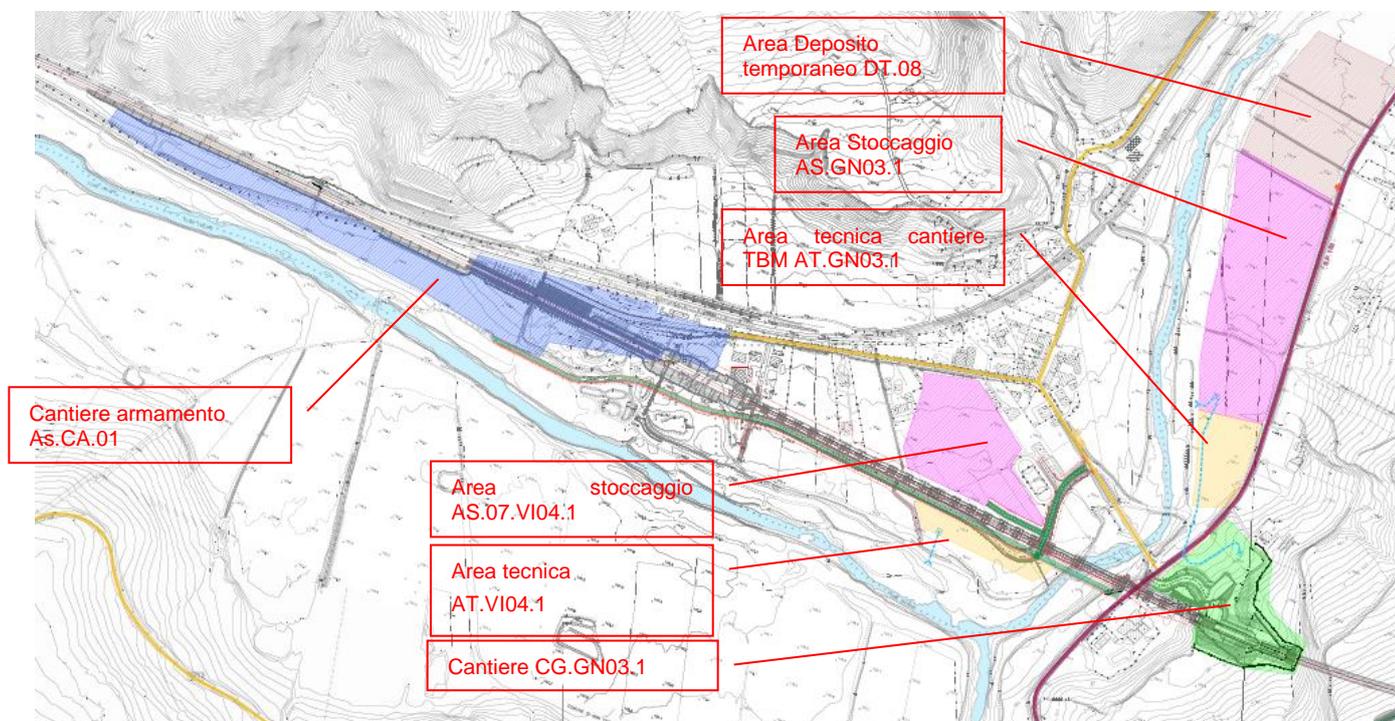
Area Rocchetta: inquadramento generale sistema di cantierizzazione
